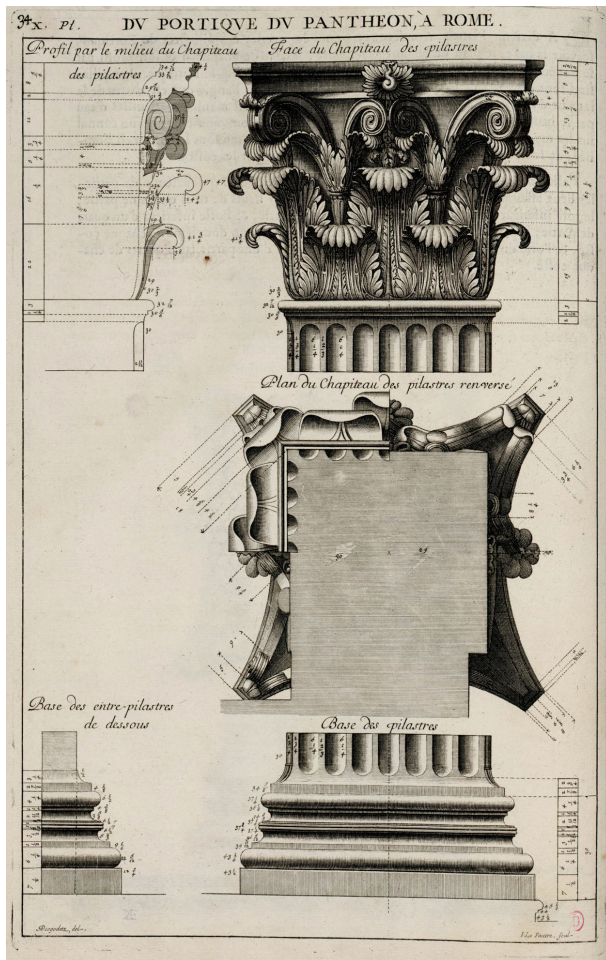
Pilastra del pórtico del Panteón. Desgodets 1682.
